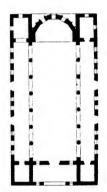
Bafilika in Turmanin. Grundriss.
